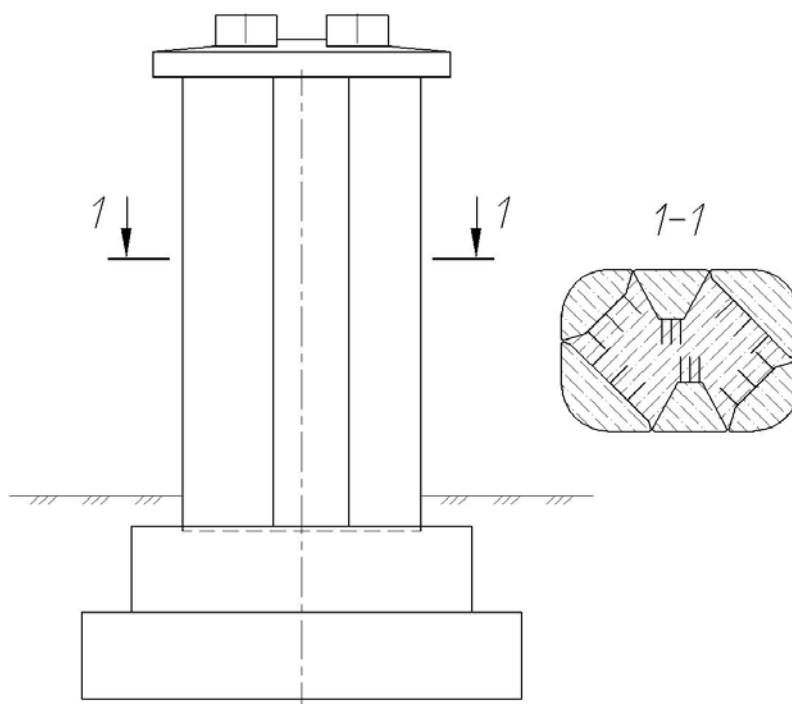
Опоры с вертикальными железобетонными контурными блоками.
